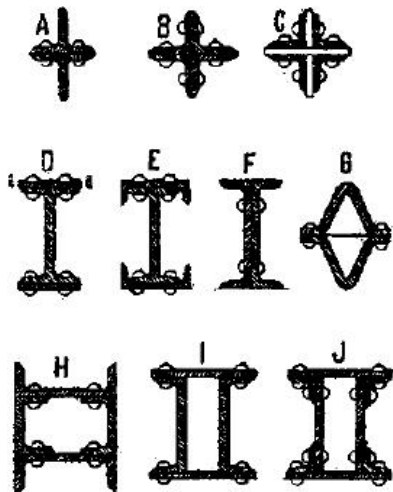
Estructuras de pilares metálicos de apeo de huecos en planta baja. Tratado de Florencio Ger, 1898
